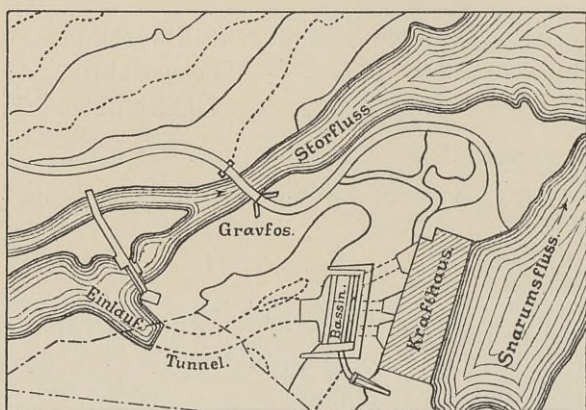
Gravfos. Lageplan. Maßstab 1 : 3300.
